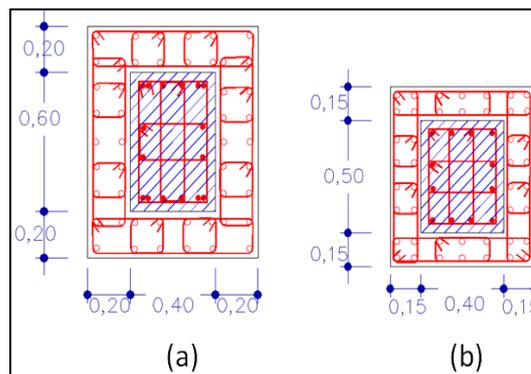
Distribución del acero de refuerzo y nuevo espesor de columnas reforzadas. (a) Columnas de 1er y 2do nivel, (b) Columnas de 3er y 4to nivel.
